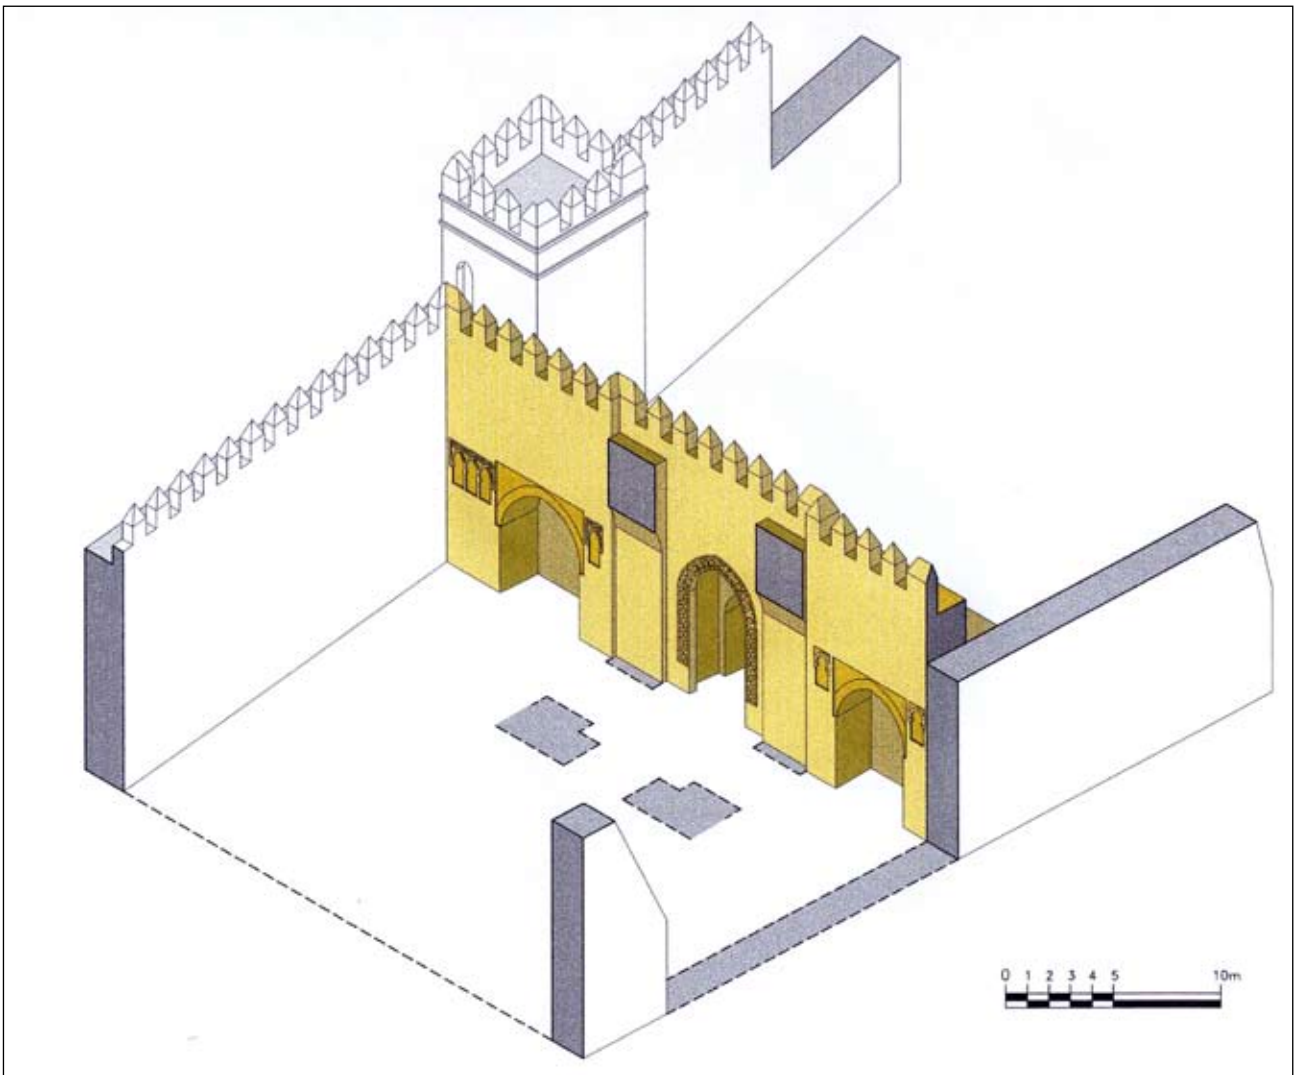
Reconstrucción idealizada de la Puerta del León-Montería tras las obras de Pedro I sobre 1356.
